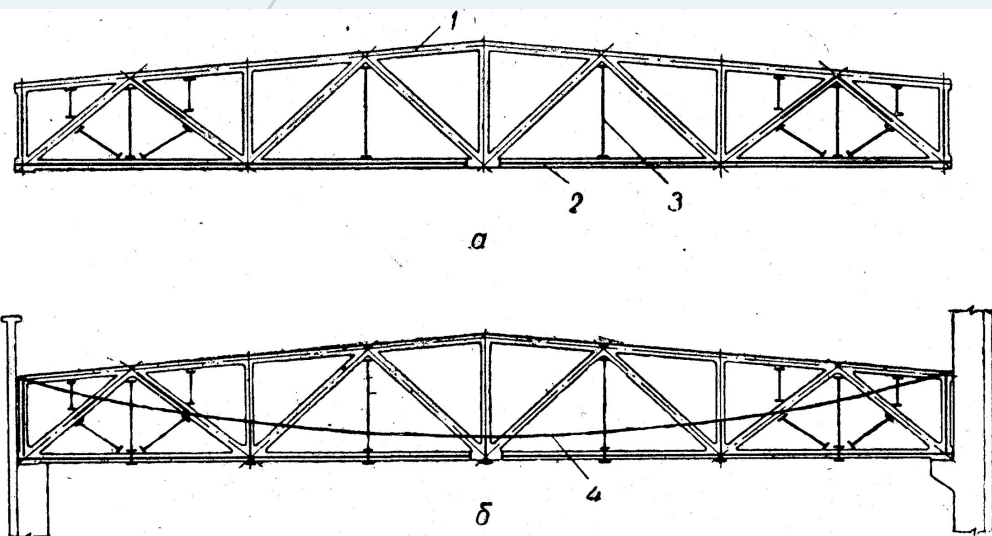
Схема усиления железобетонной фермы предварительно-напряженной цепью:
